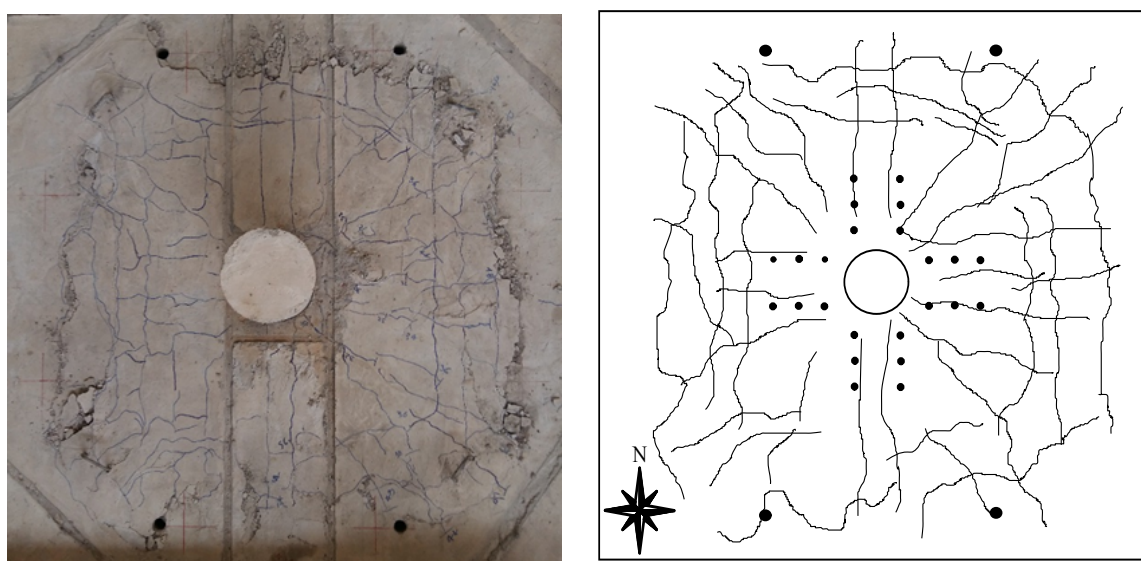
Mapa de fissuração - Laje BD-A01
